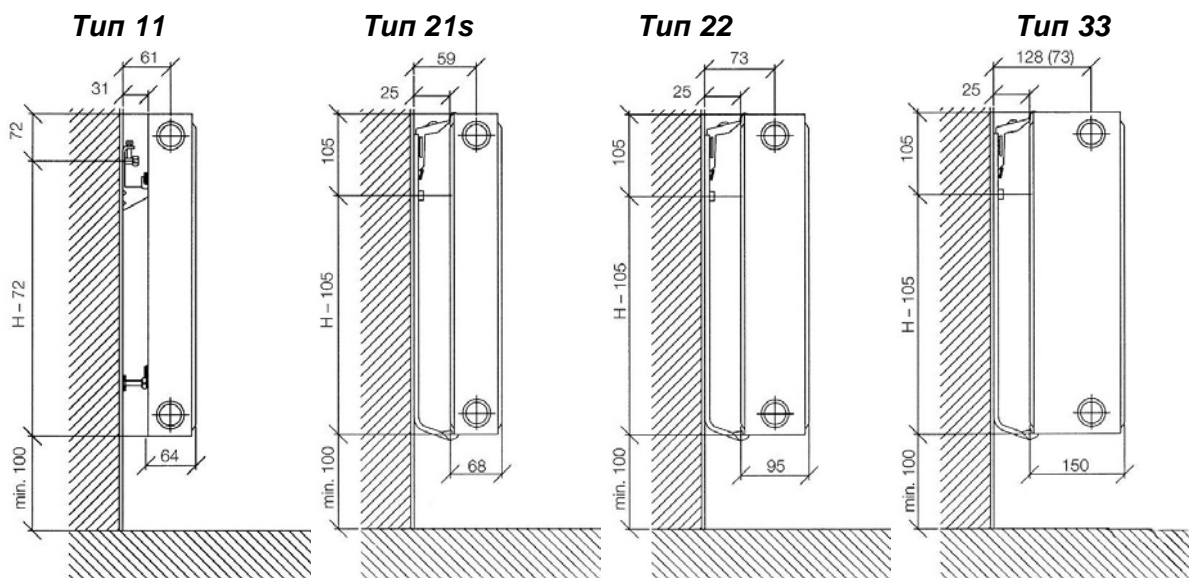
Общий вид и габаритные размеры радиаторов «DiaVentil»
